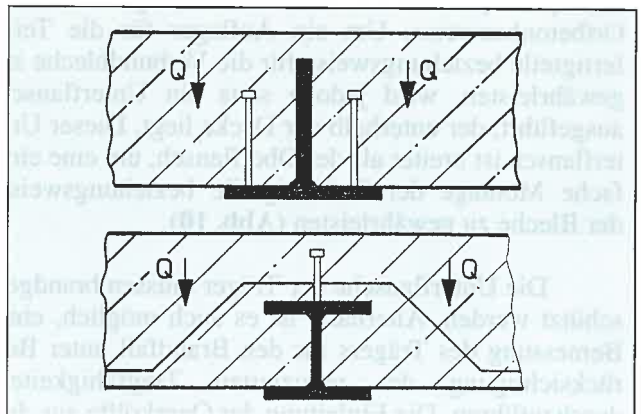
Sicherstellung des Deckenauflegers im Brandfall
